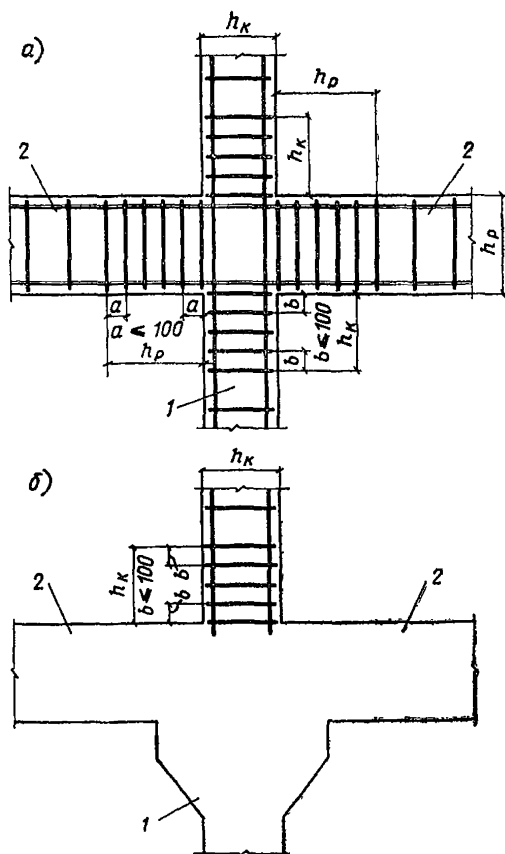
Армирование поперечной арматурой участков колонн и ригелей, примыкающих к узлу
